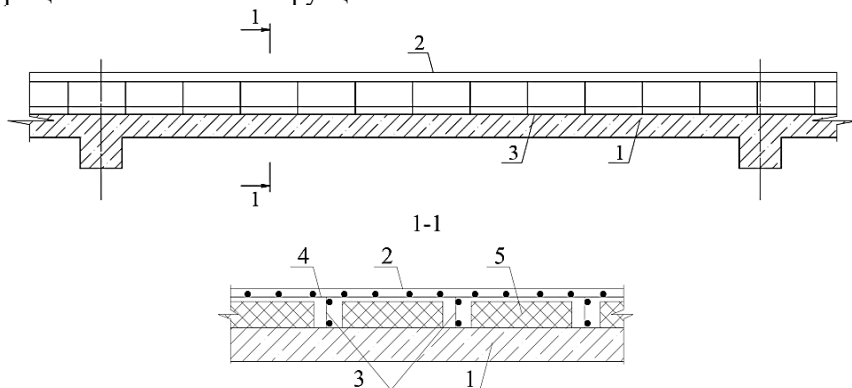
Устройство дополнительной монолитной ребристой плиты из фибробетона сверху:
